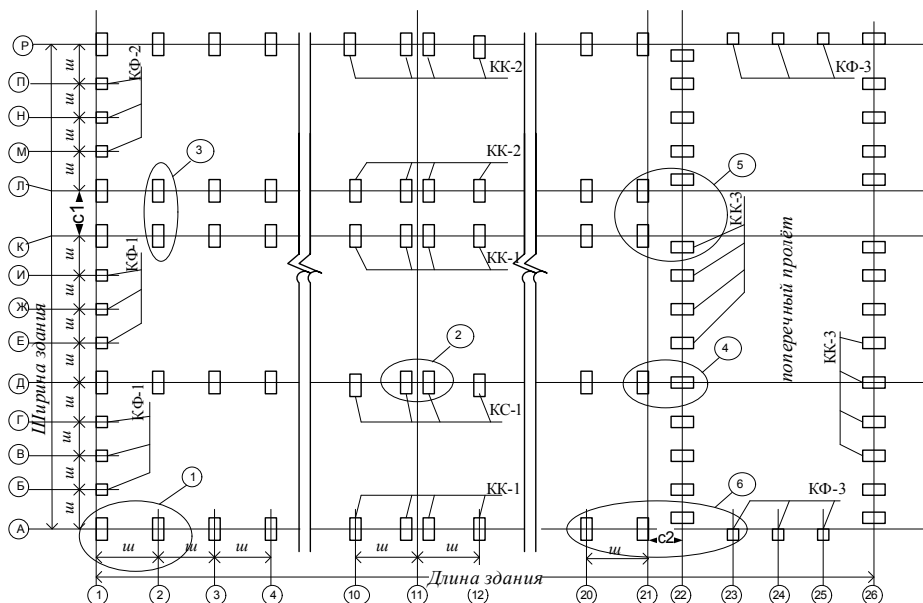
Схематический план одноэтажного промышленного здания с тремя продольными и одним поперечным пролетами.
